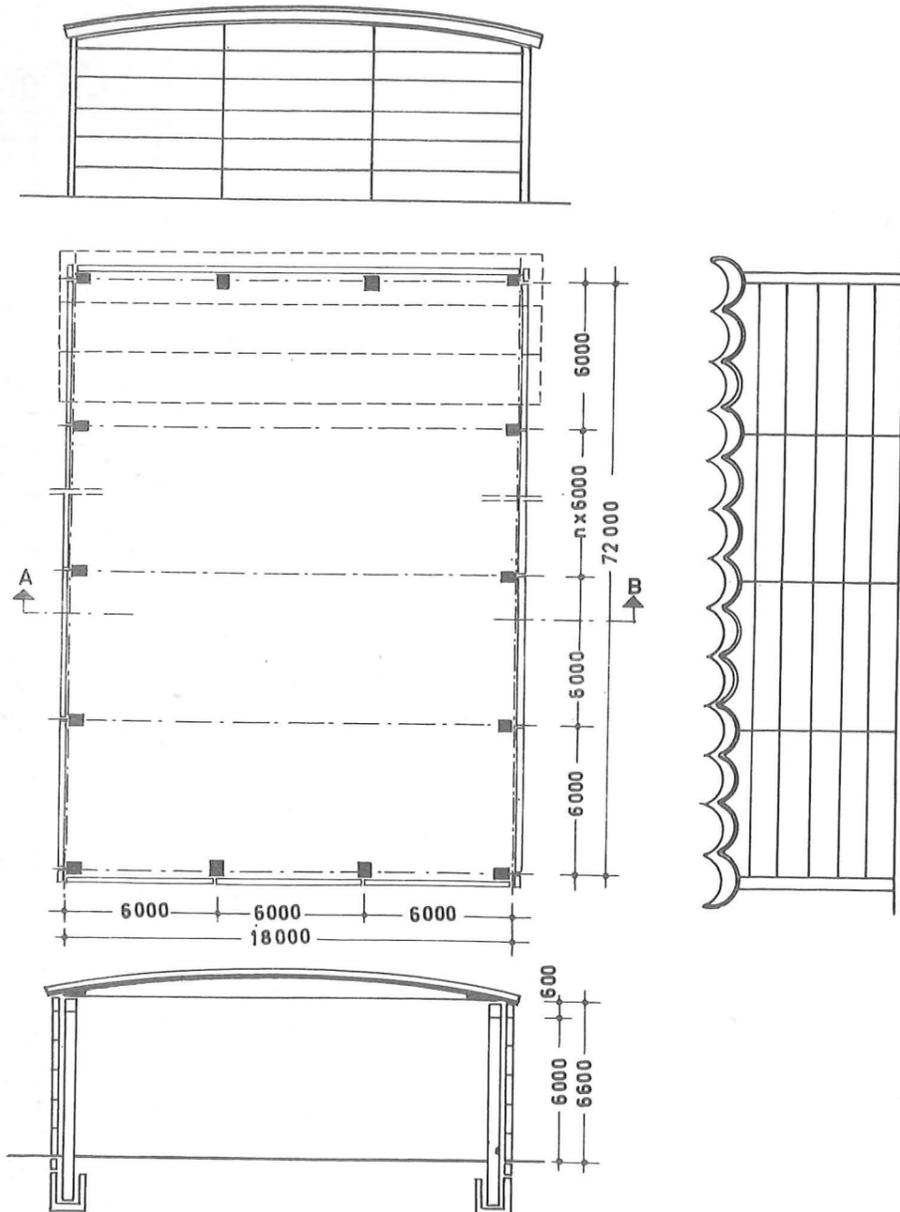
Eingeschossige Gebäude mit HP-Schalen - Mustergebäude mit Fassadenbeispielen
